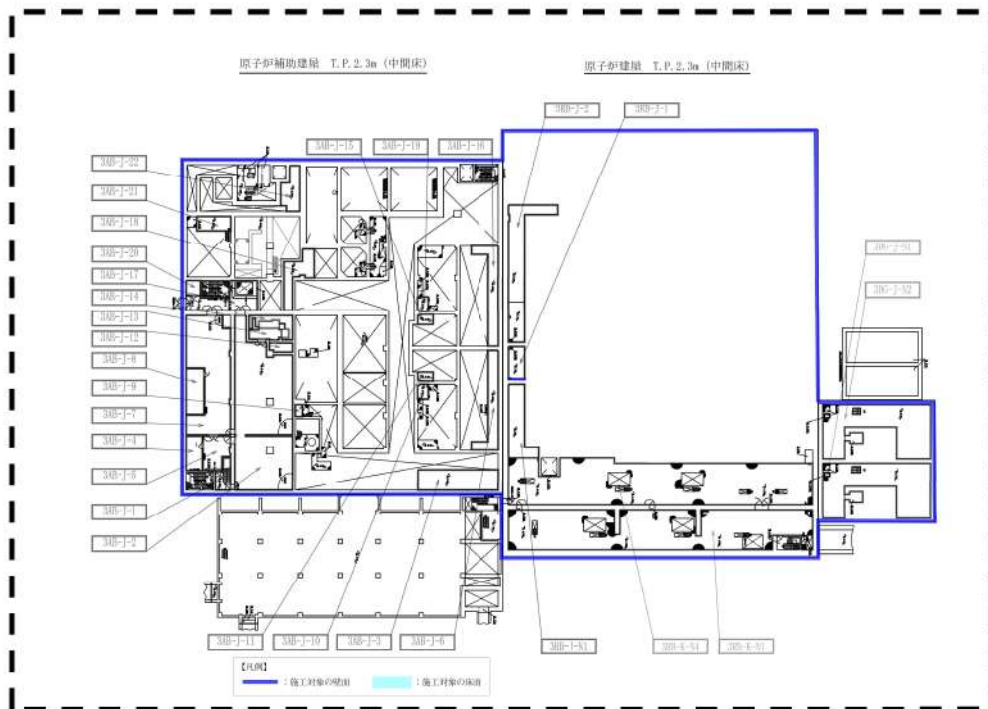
溢水防護対策施工対象の壁及び床の配置図 (8/11)
